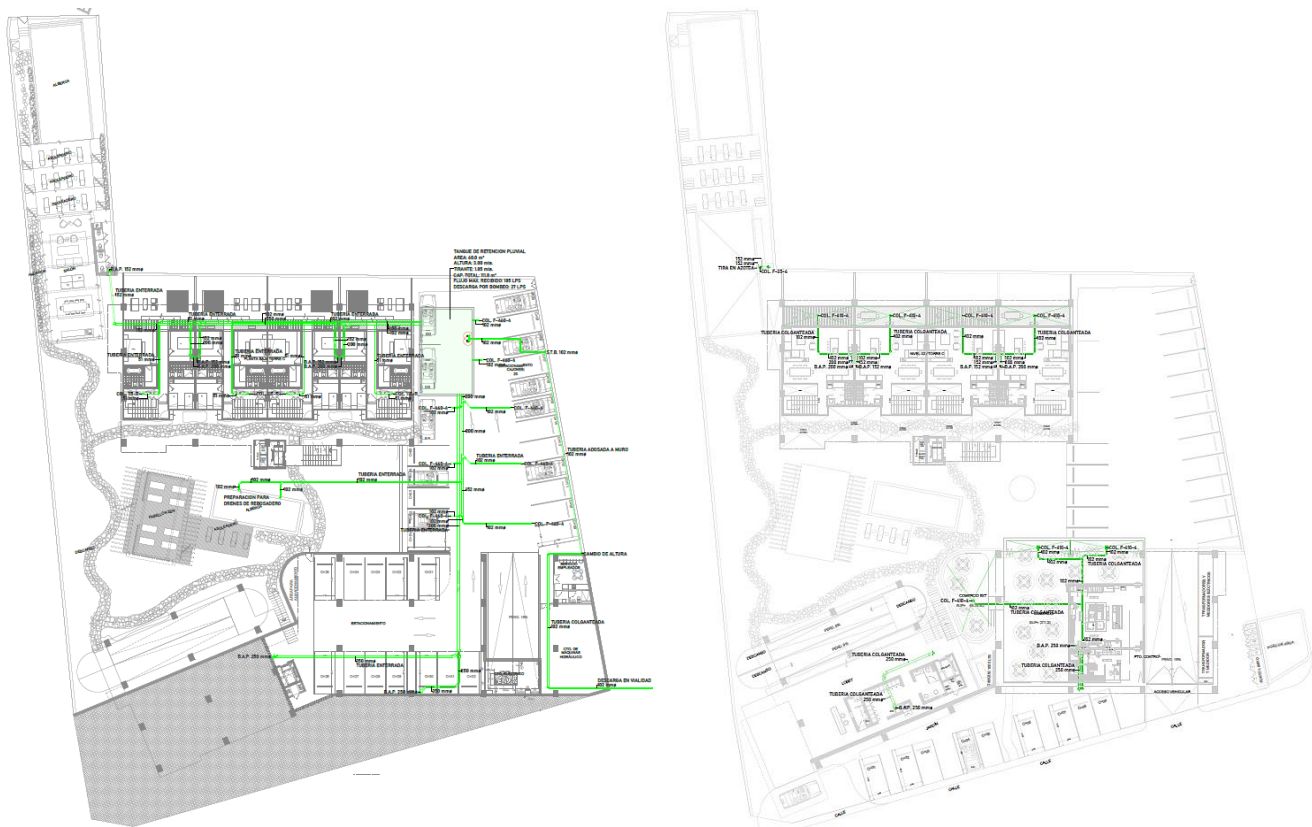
Instalación de la red general de drenaje pluvial en el nivel de sótano y la planta baja del proyecto
